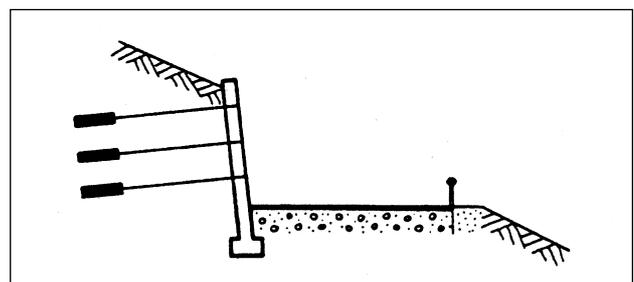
Muro di spalla in cemento armato con ancoraggio posteriore:
